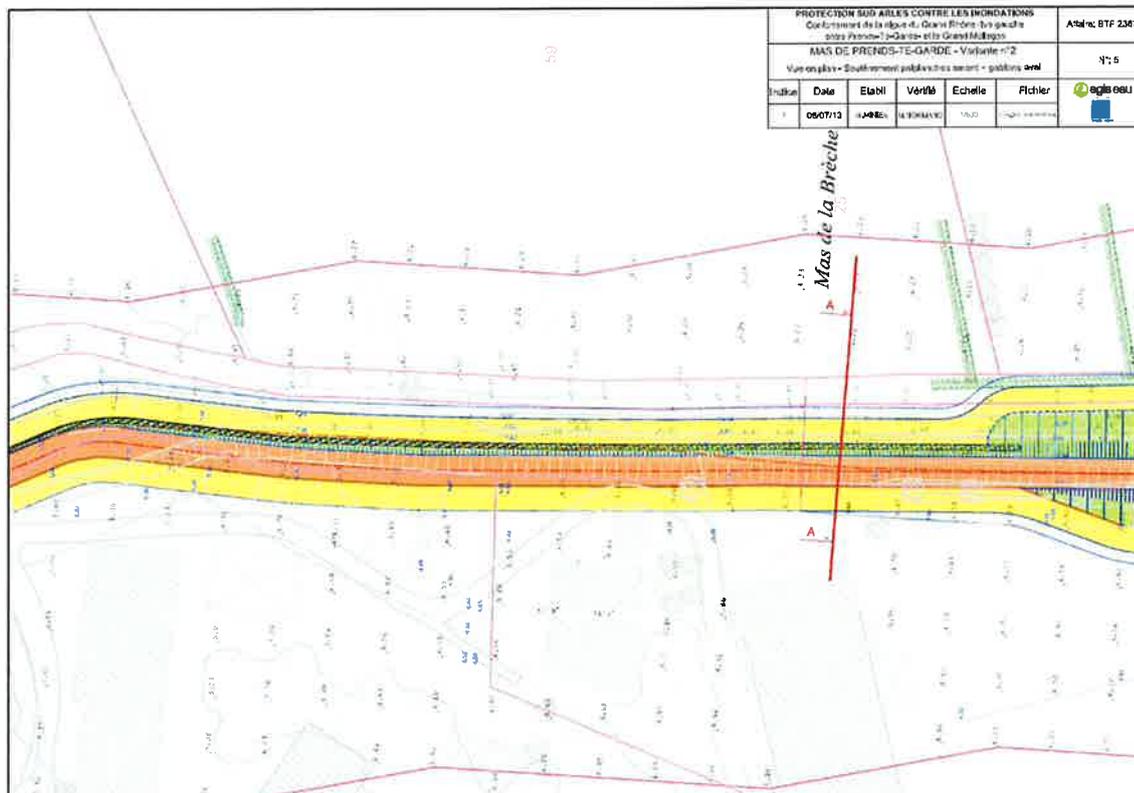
Tracé en plan de l'emprise de la digue à l'aval de Prends-té-Garde
